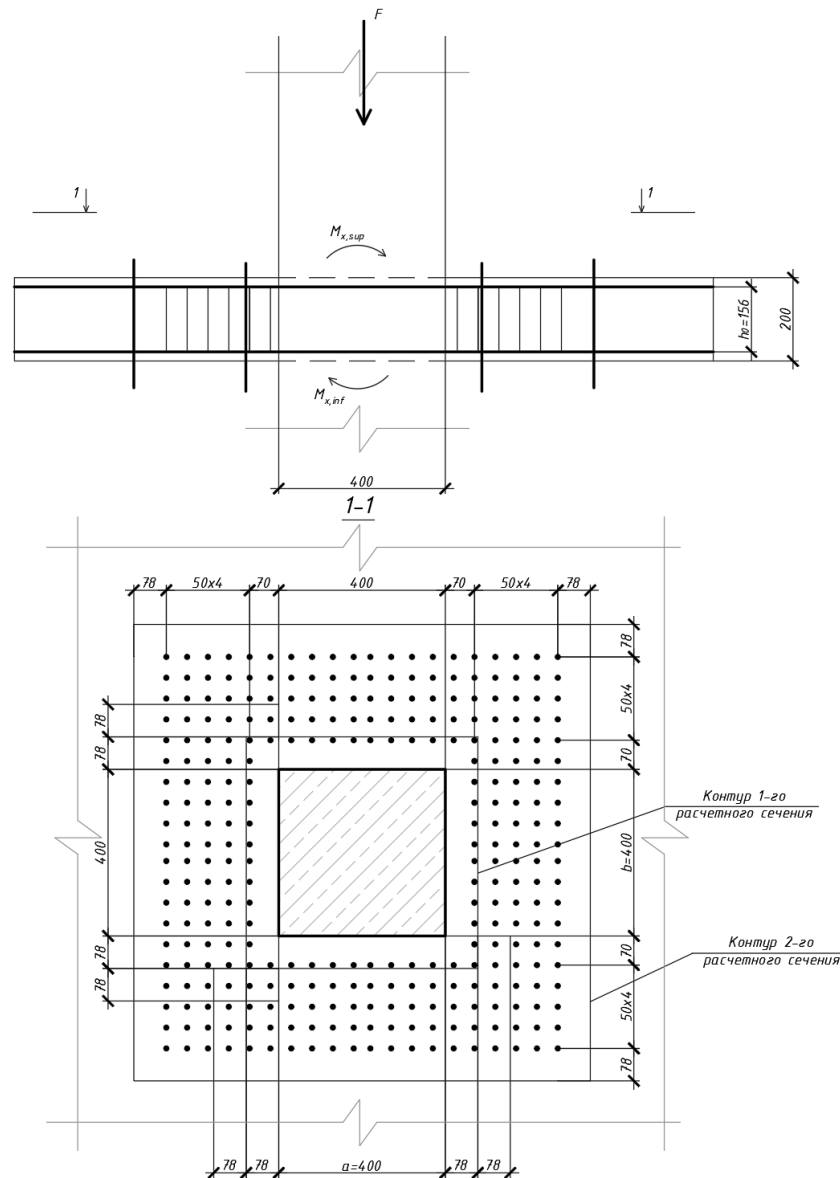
Расчет плиты перекрытия на продавливание
